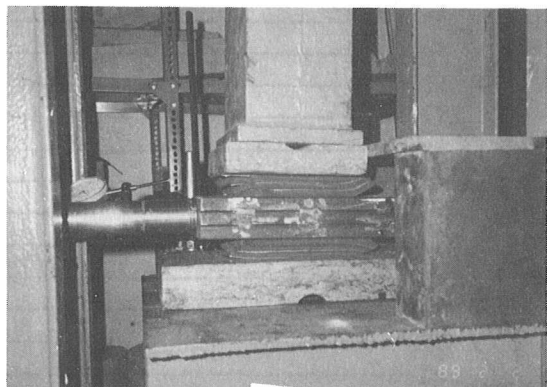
Ensayo de control de adherencia entre elastómero y armaduras (MELC 1015) de los apoyos antiguos.
